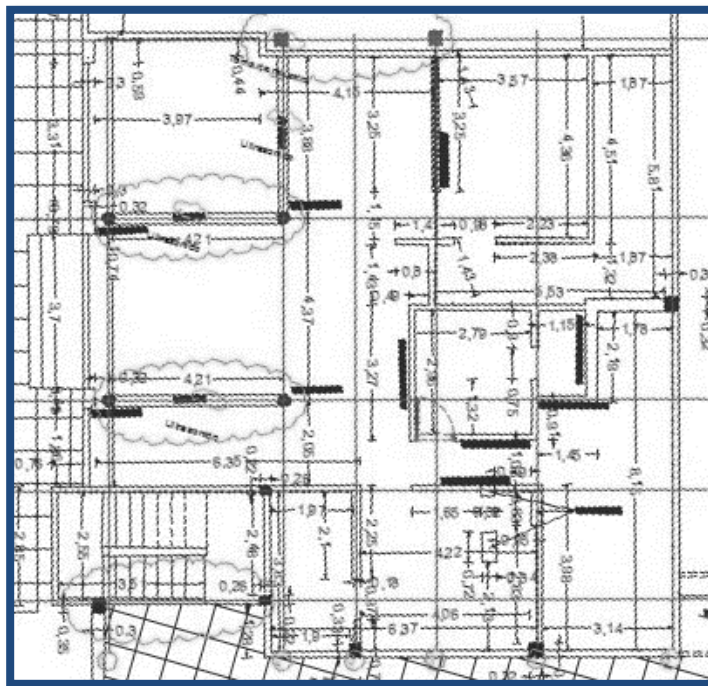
Levantamiento estructural primer piso edificio#1. Fuente: Autores,2018.
